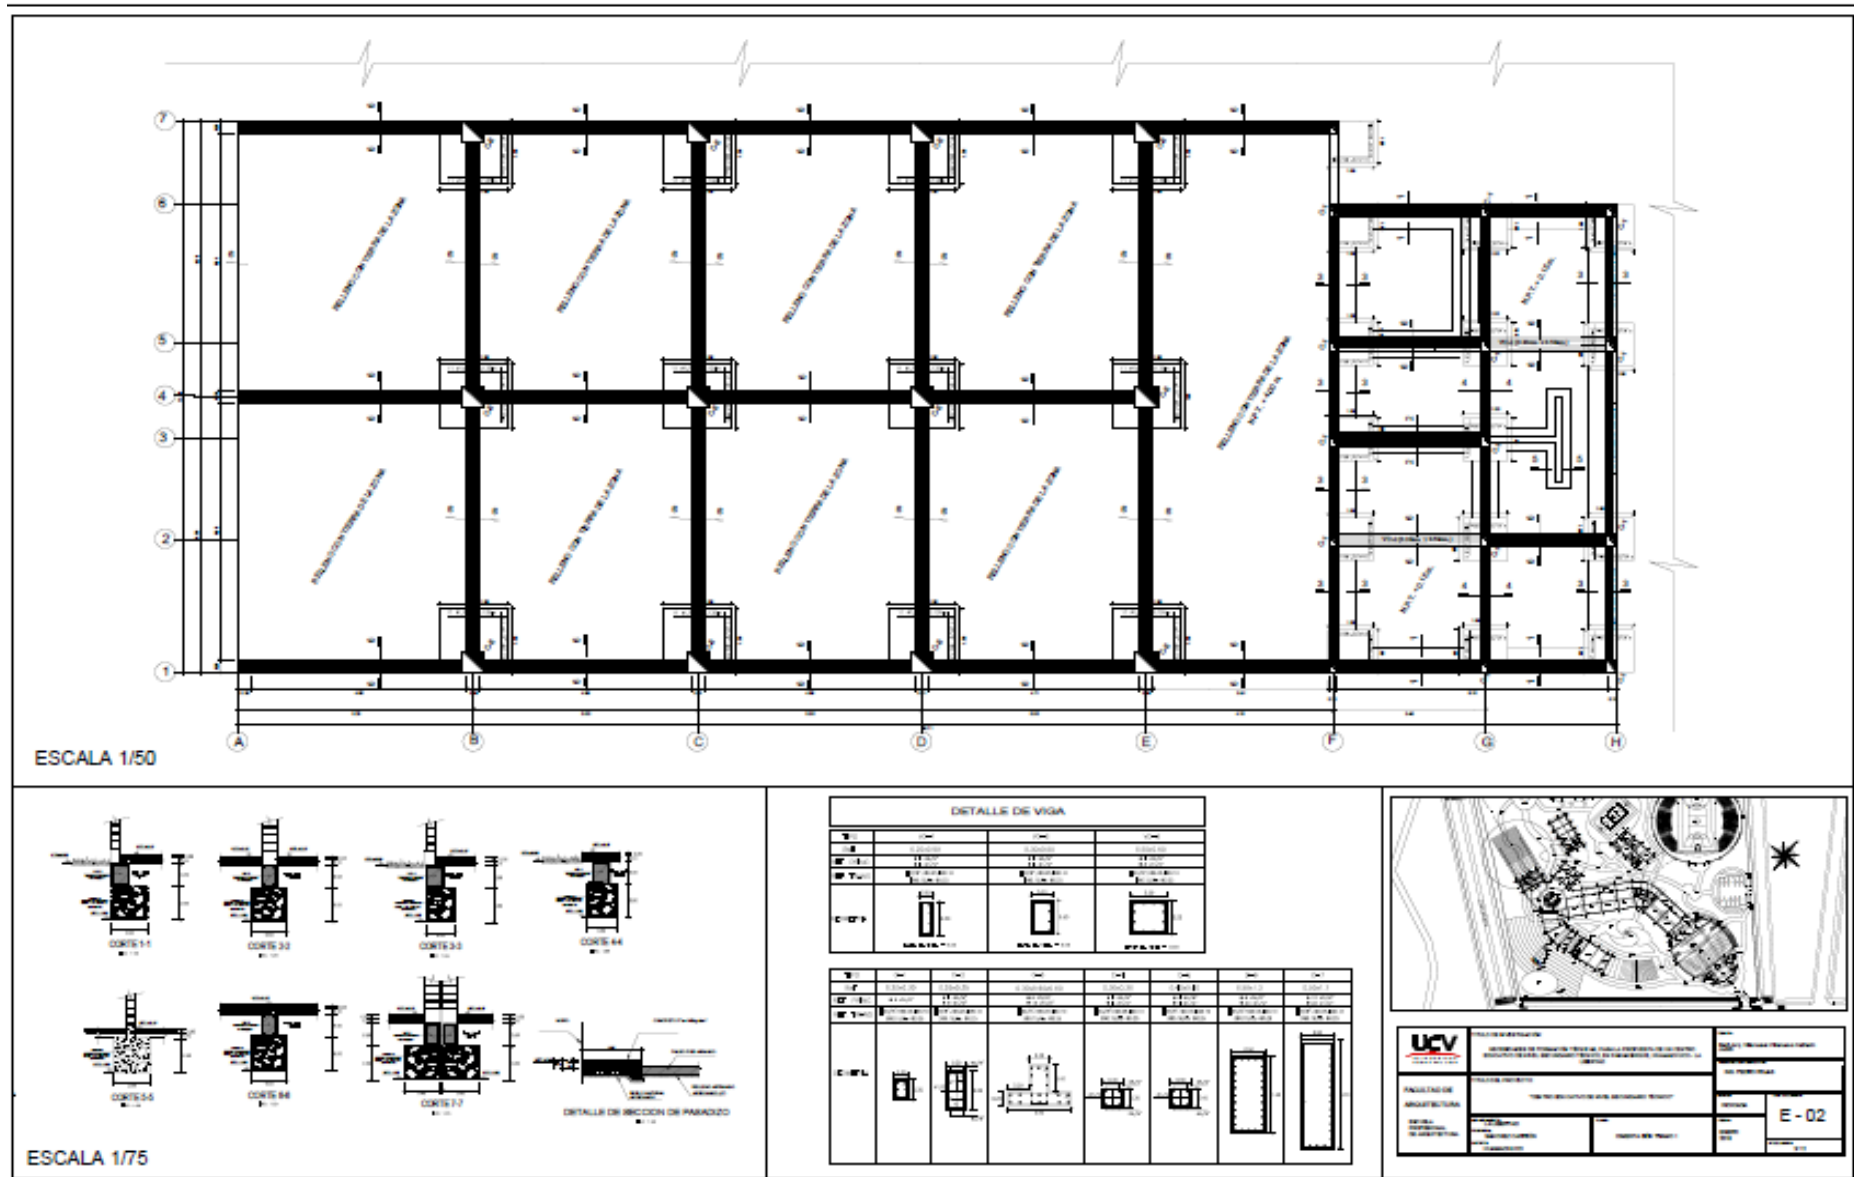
Plano Diseño Estructural Bloque 01 – Cimentación - Plano N° 10 - Lamina E-02
